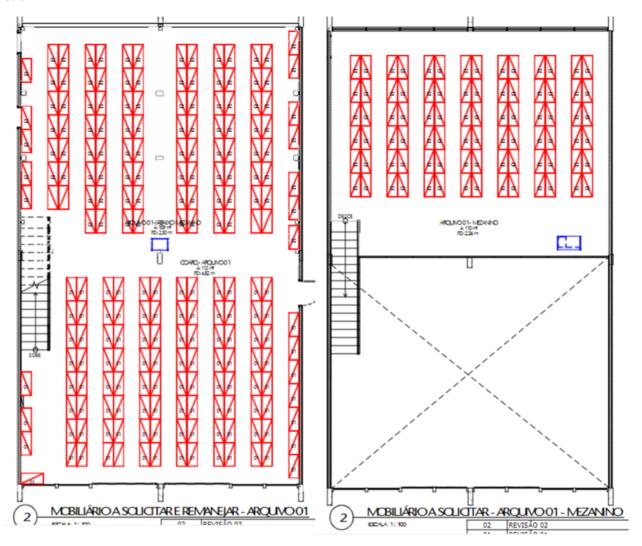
Layout proposto sala 1 - térreo e pavimento superior, conforme documento 00100.082557/2021, pranchas 04 (Térreo: 106 estantes com capacidade para 25 caixas e 107 estantes com capacidade para 30 caixas) e 05 (pavimento superior com capacidade para 84 estantes para 25 caixas em cada)
